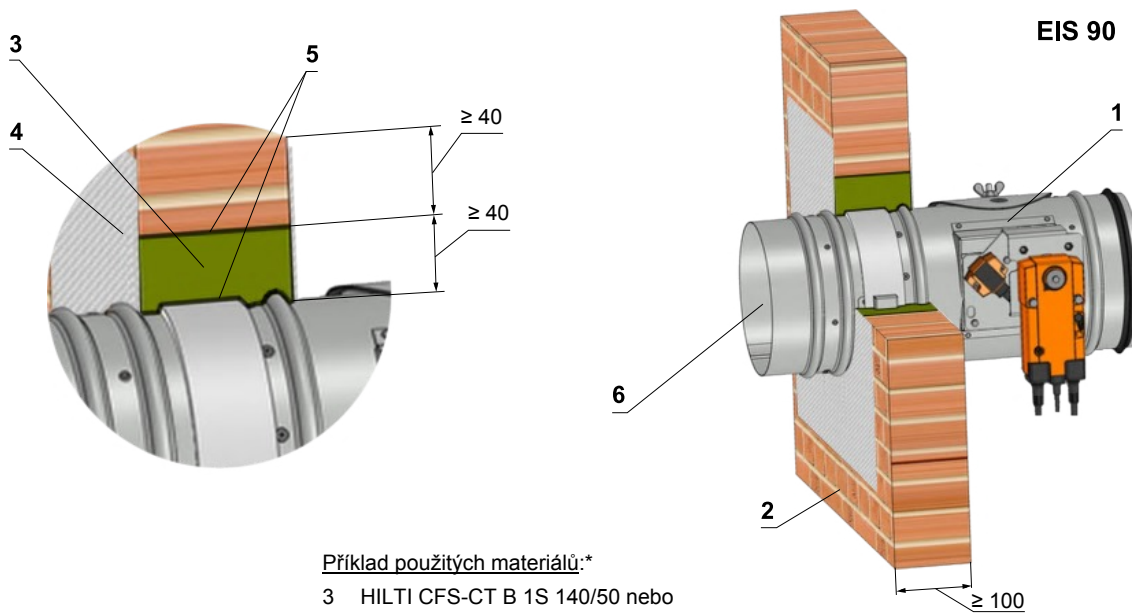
Tuhá stěnová konstrukce - sádra nebo malta
